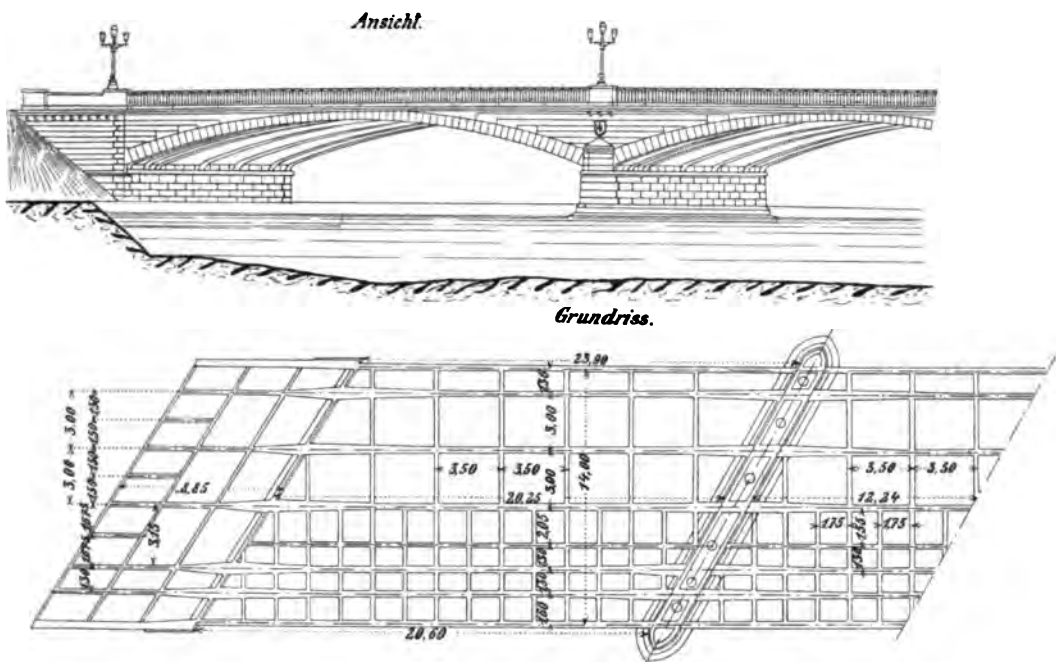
Ansicht und Grundriß der Brücke zu Soissons.
